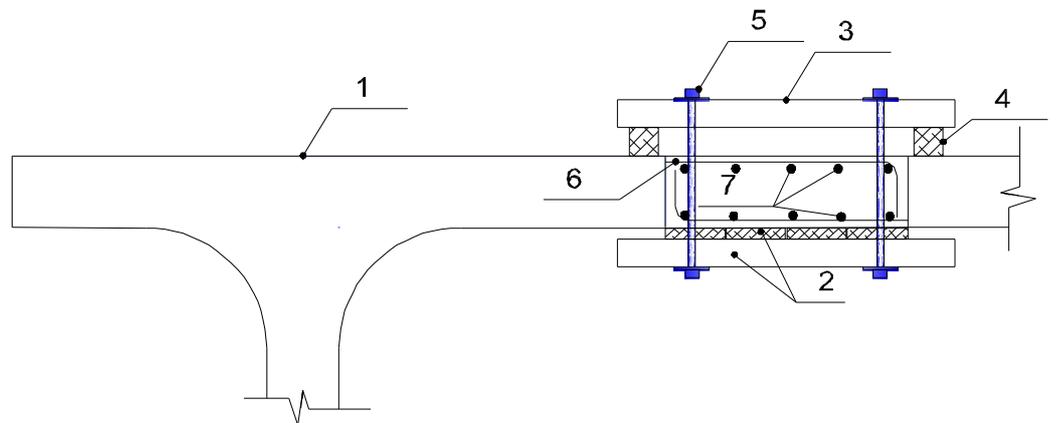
Омоноличивание балок по плите проезжей части: 1-балка; 2-опалубка; 3-поперечный брус; 4-продольный брус; 5 - шпильки с гайками и шайбами, пропускаемые в полиэтиленовые трубки; 6-выпуски арматуры из плиты балки; 7-продольная противоусадочная арматура, устанавливаемая при монтаже
